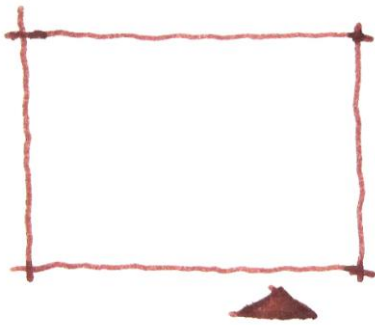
Esquemas de sistema constructivo. Autora. S.L.G.
